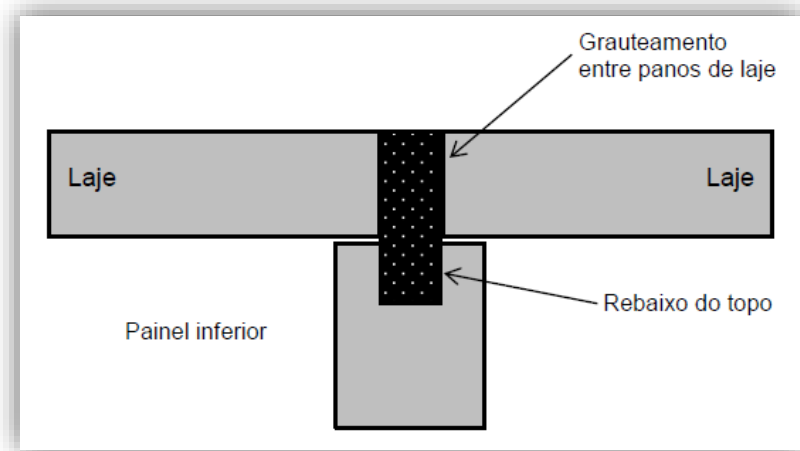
Grauteamento da ligação entre os painéis, uso de fundo de junta
